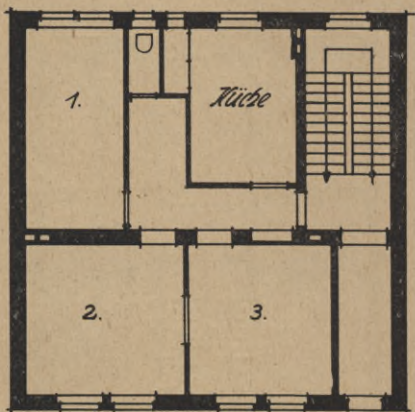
Eingebautes Haus mit 3-Zimmerwohnungen.
